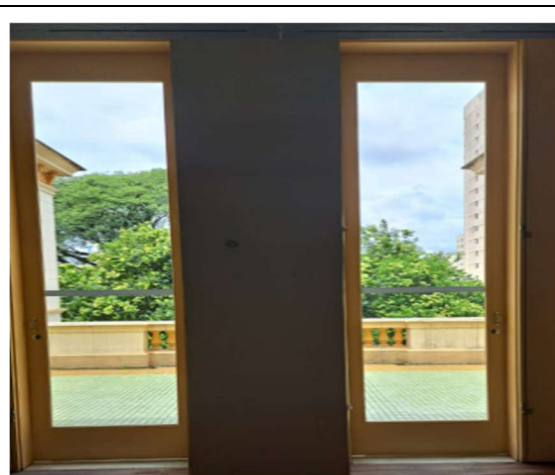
Manutenção corretiva, porta de acesso à varanda primeiro pavimento.
